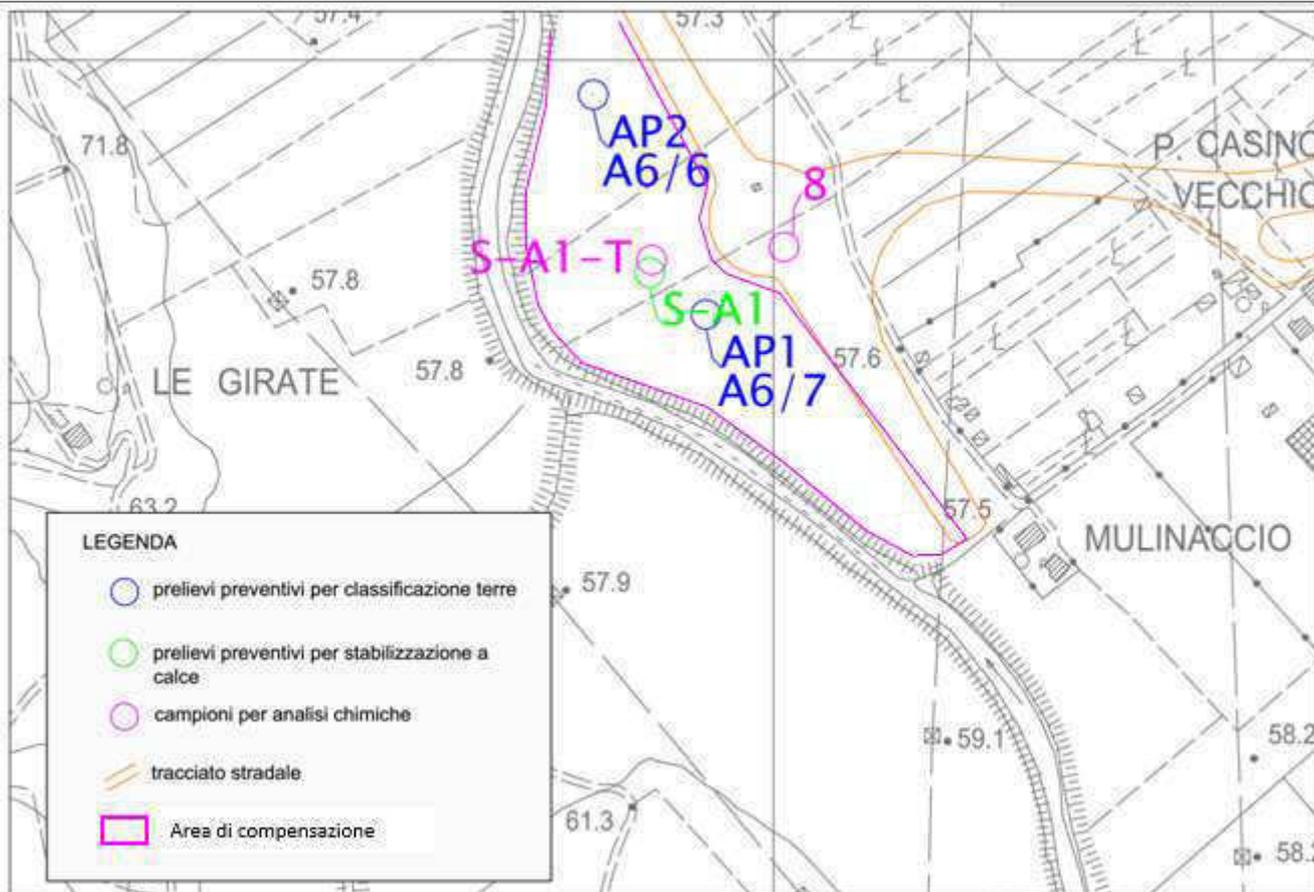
Campioni prelevati. In magenta l'area di compensazione. In arancione il tracciato stradale
